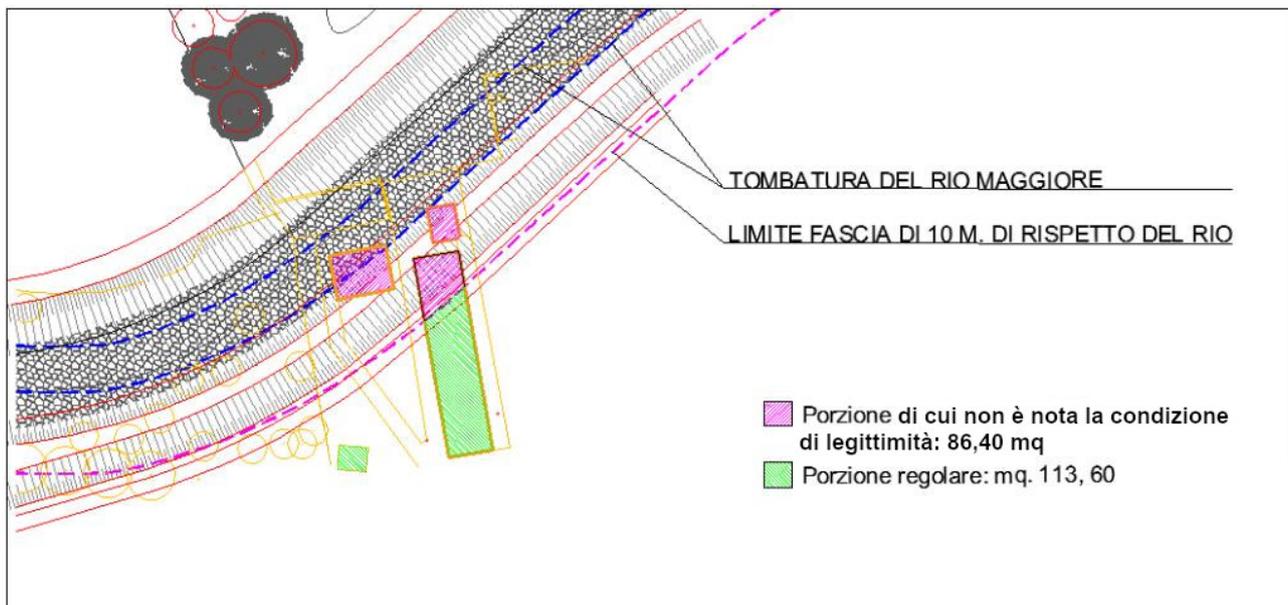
Planimetria con indicata la posizione degli spogliatoi del campo di calcio.
